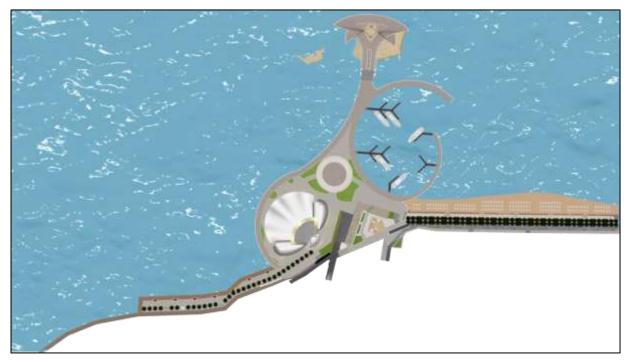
Plan d'aménagement Source : Cree par l'auteur
